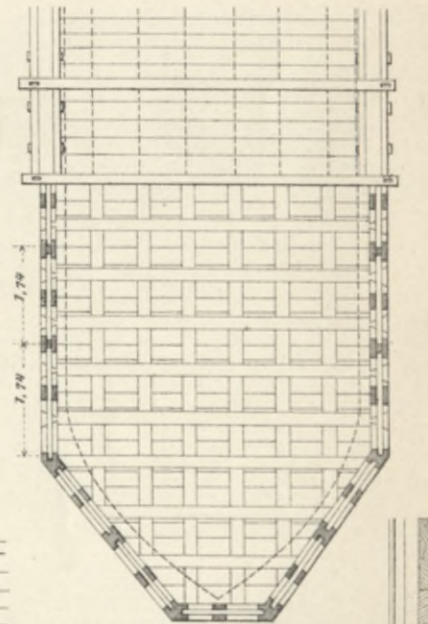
u. 32. Senkkasten vom Pfeilerbau der Donaubrücke bei Donauwörth. M. 1:125.
